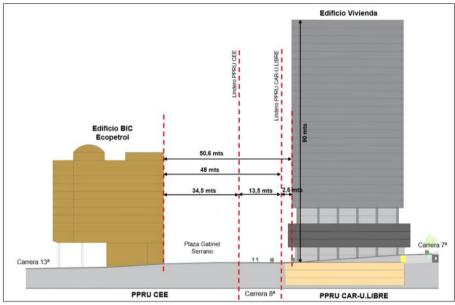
Aislamiento entre Edificio Ecopetrol y Torres del Plan Parcial CAR-UL
